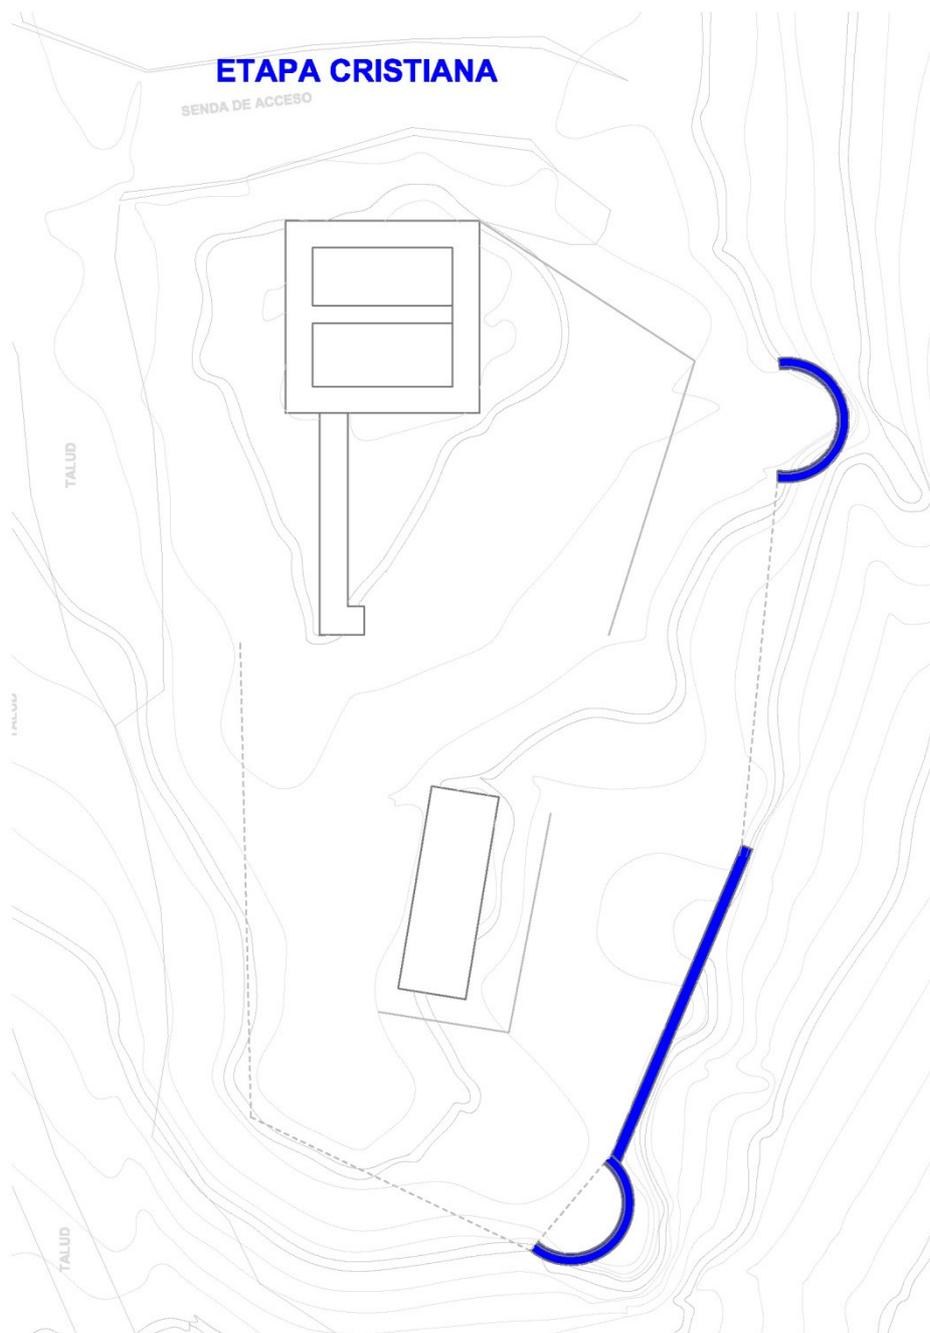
Plano en el se marca las edificaciones de origen cristiano.
